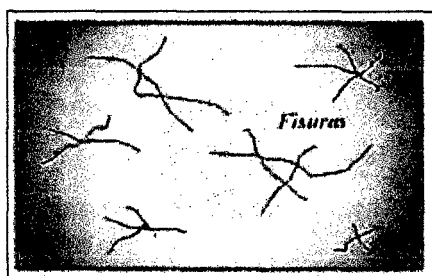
19. Fisuración en estrella por ataque químico árido – álcali. Fuente: (Stuardo P., 2008)
